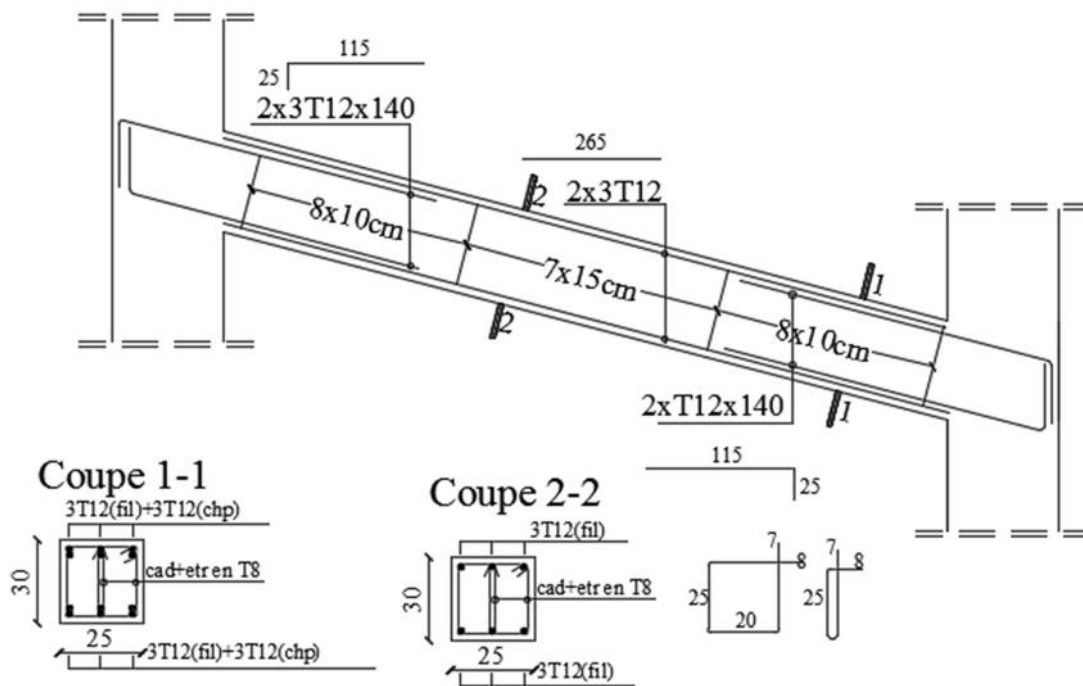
Ferrailage de la poutre palière des étages RDC, E-sol et service.
